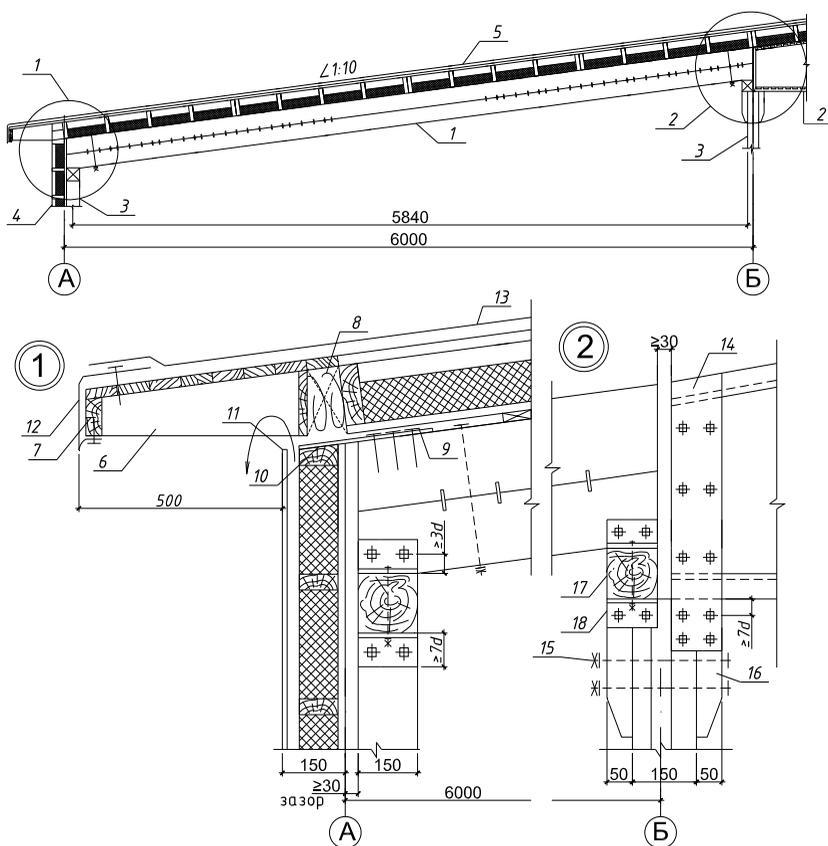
Фрагмент покрытия здания балкой на пластинчатых нагелях:
